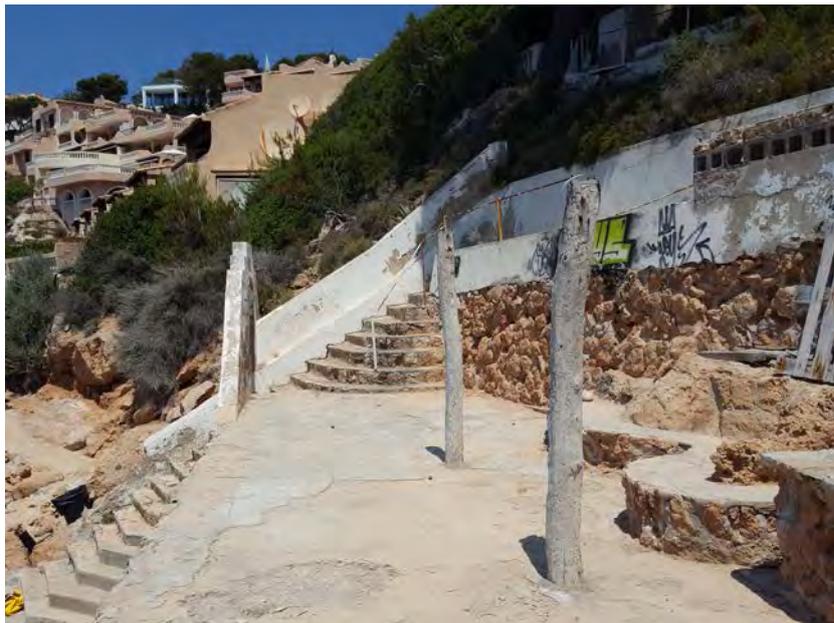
Vista de escaleras de acceso a plataforma-solárium y al mar
